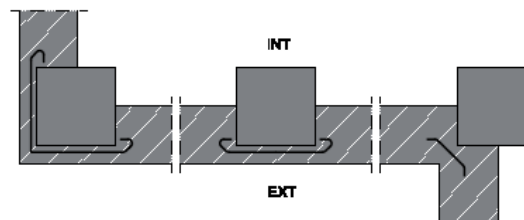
Ejemplo de encuentro de la fachada con los pilares
